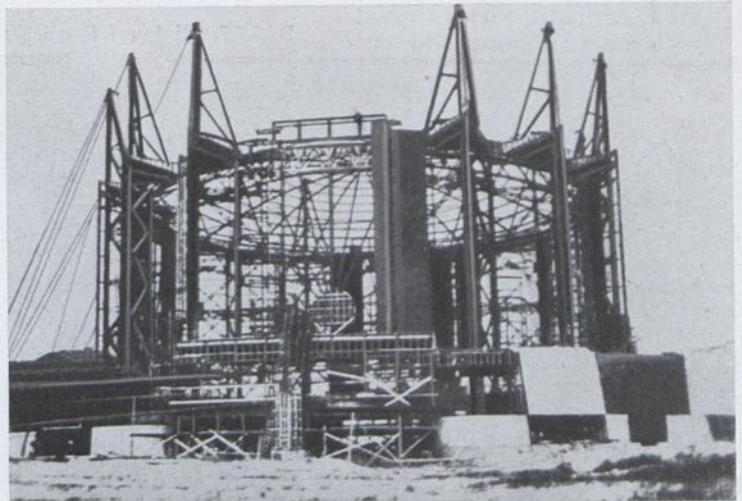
Halle auf der Chicagoer Weltausstellung 1931.
